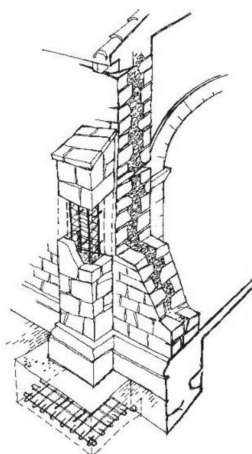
Renforcement d'un plancher par un montant intermédiaire.
